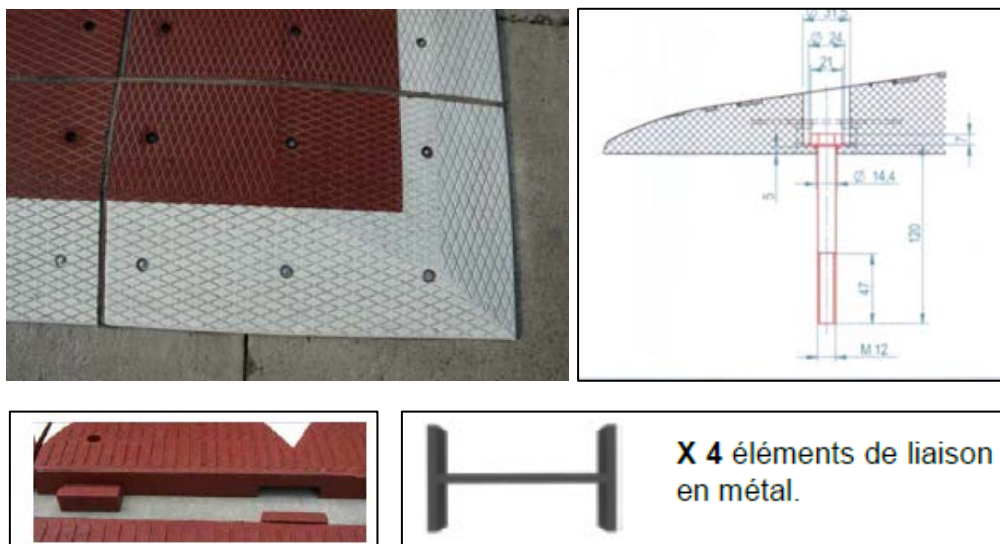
Modes de fixation et de liaison des éléments constituant un coussin à poser sur la chaussée
